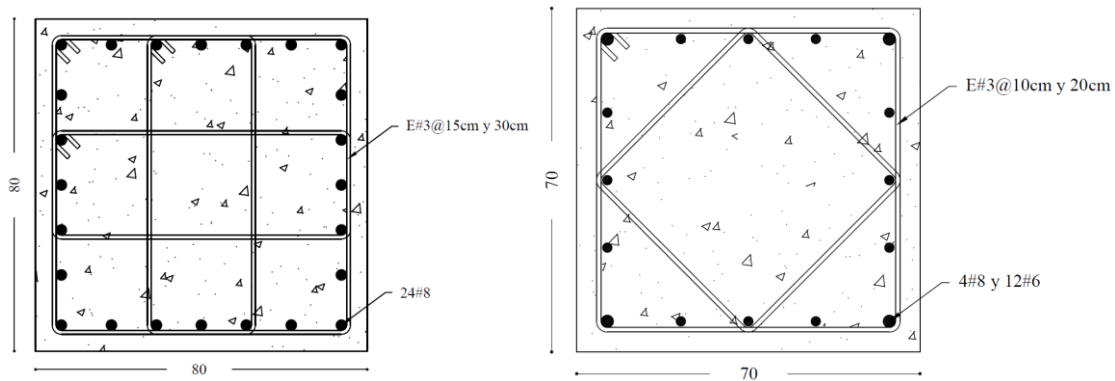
a) Sección transversal de columna para estructura sin aislamiento (izquierdo), y b) Sección transversal de columna para estructura con aislamiento (derecho)
